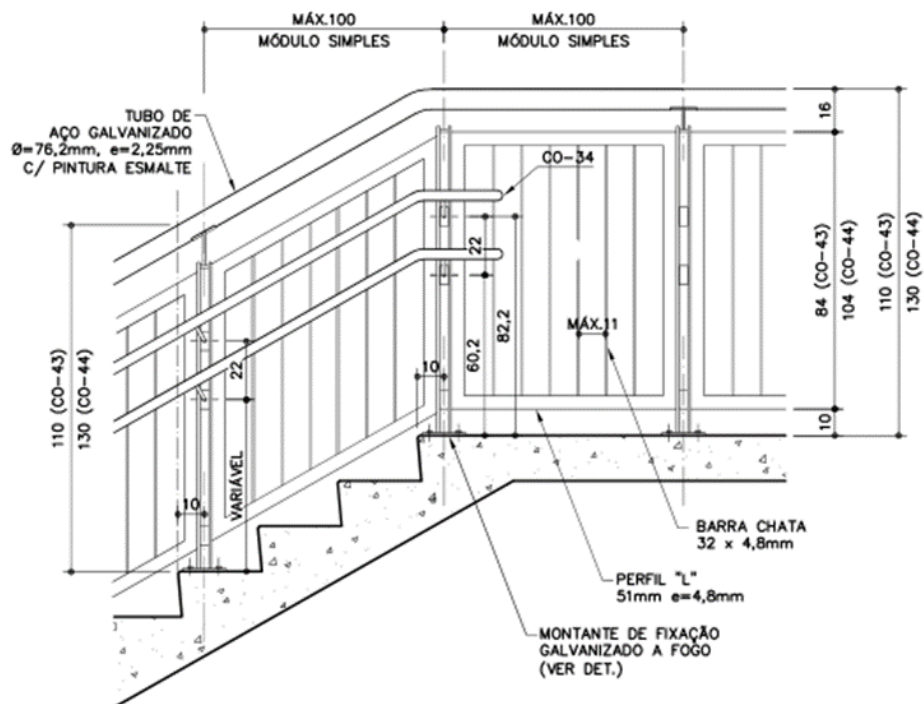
Elevação Escada - Típica - (fonte FDE)
